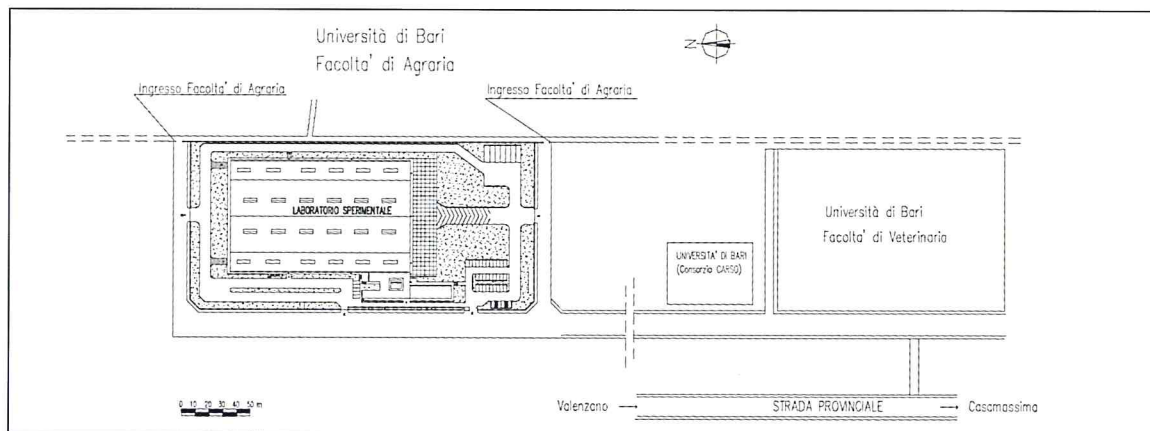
Planimetria generale ed inquadramento del LIC nell'area universitaria.
